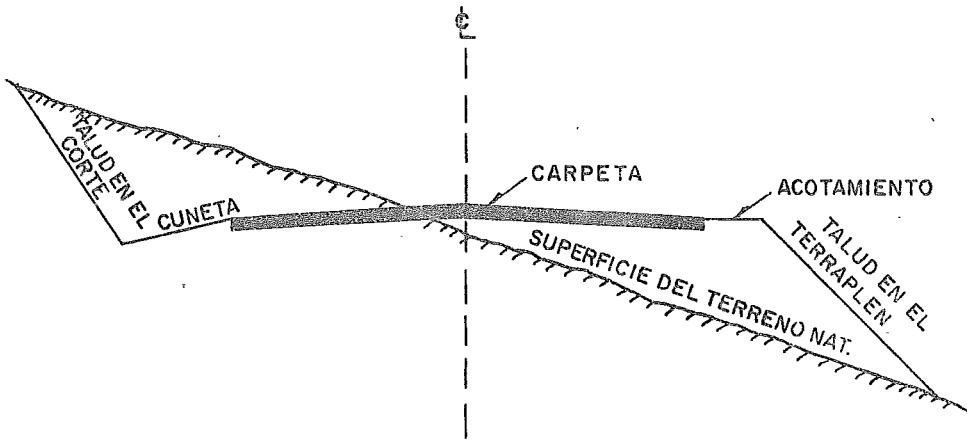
CARRETERA PROYECTADA CON TALUDES ARTIFICIALES, EN CORTE Y EN TERRAPLEN. (SECCION TRANSVERSAL EN BALCON).
